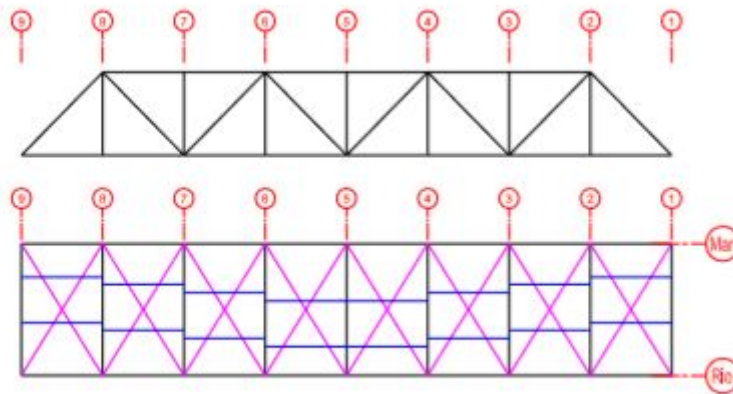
geometría de la armadura del puente y del tablero. (Arestuche, 2013)
